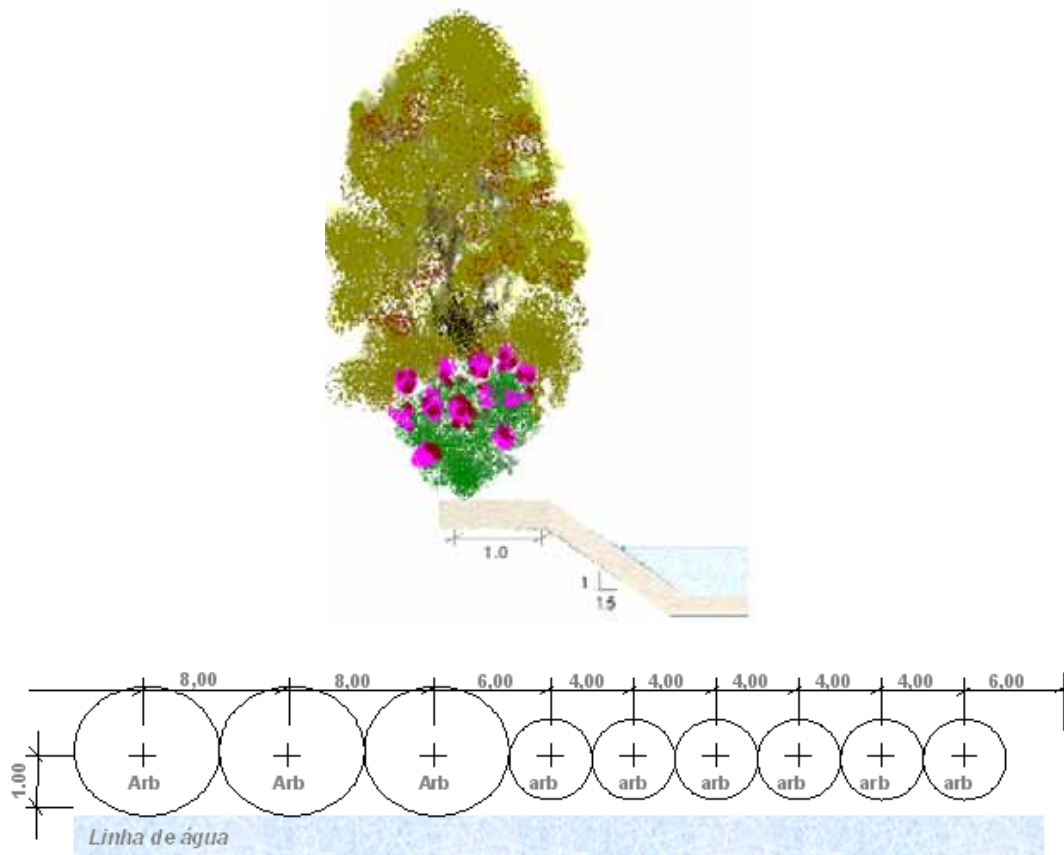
Perfil Tipo e Módulo de Plantação M3 para sem galeria ripícola
